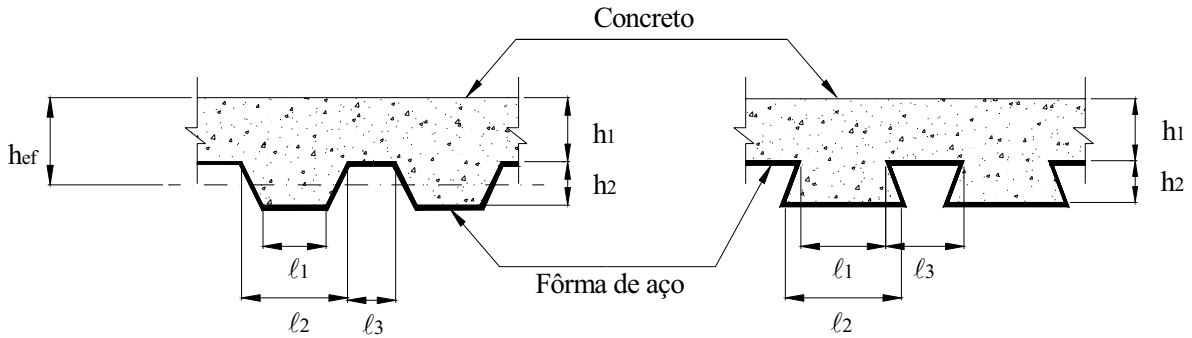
Dimensões da Seção Transversal da Laje Mista
